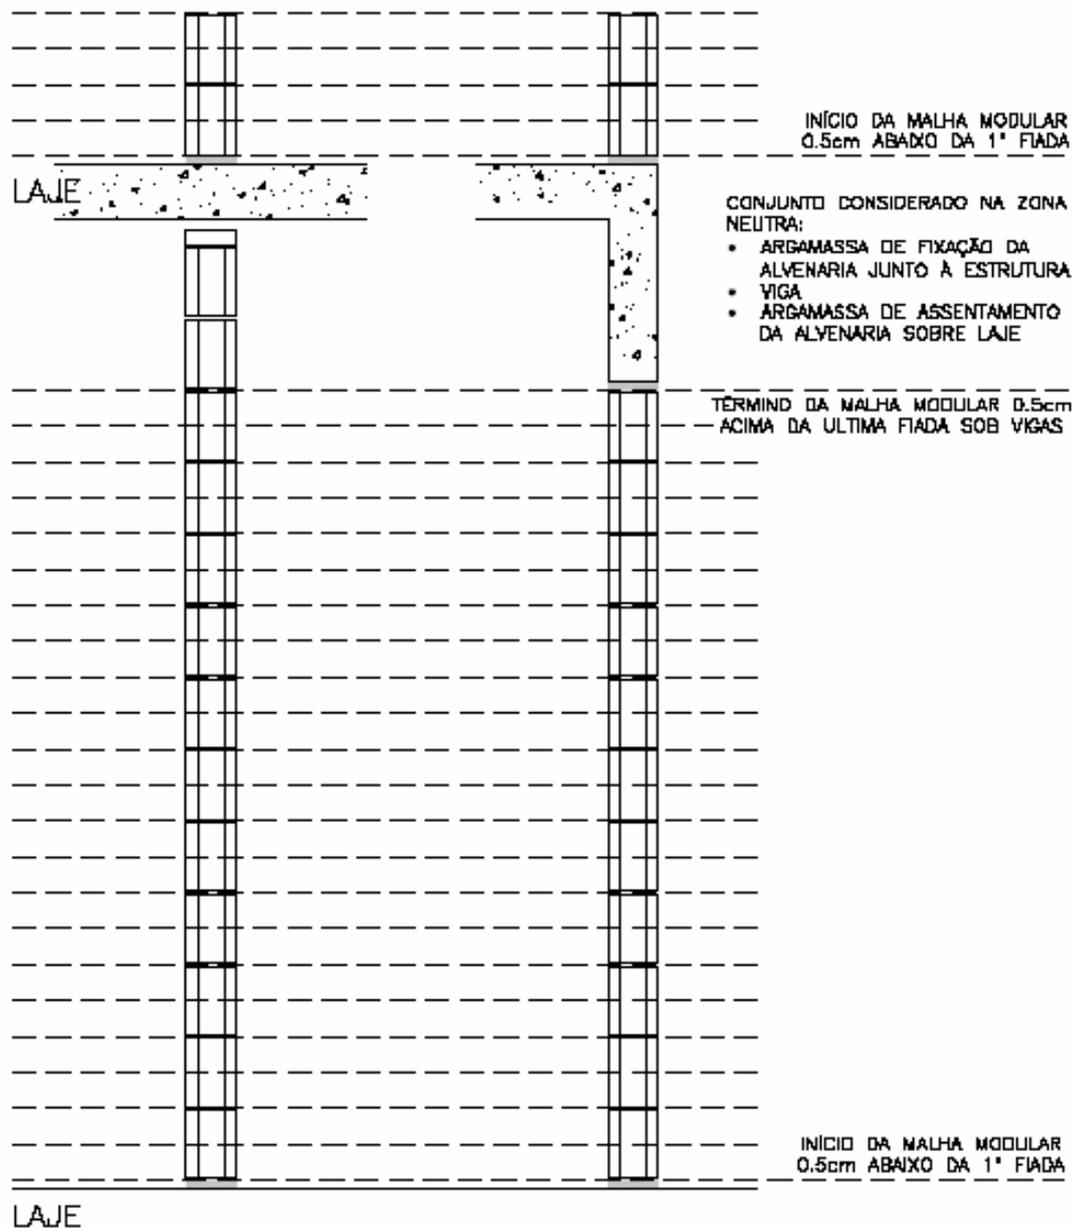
Esquemas verticais na aplicação da malha modular
